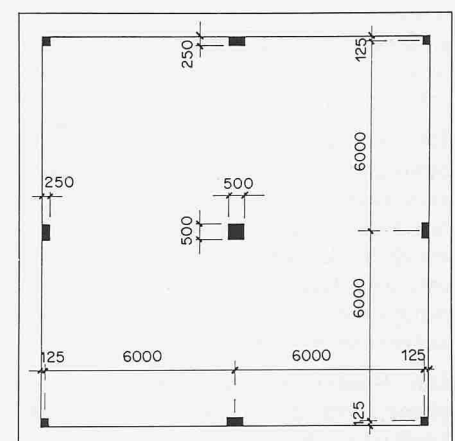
Flachdecke. Grundriss. Abmessungen [mm]
